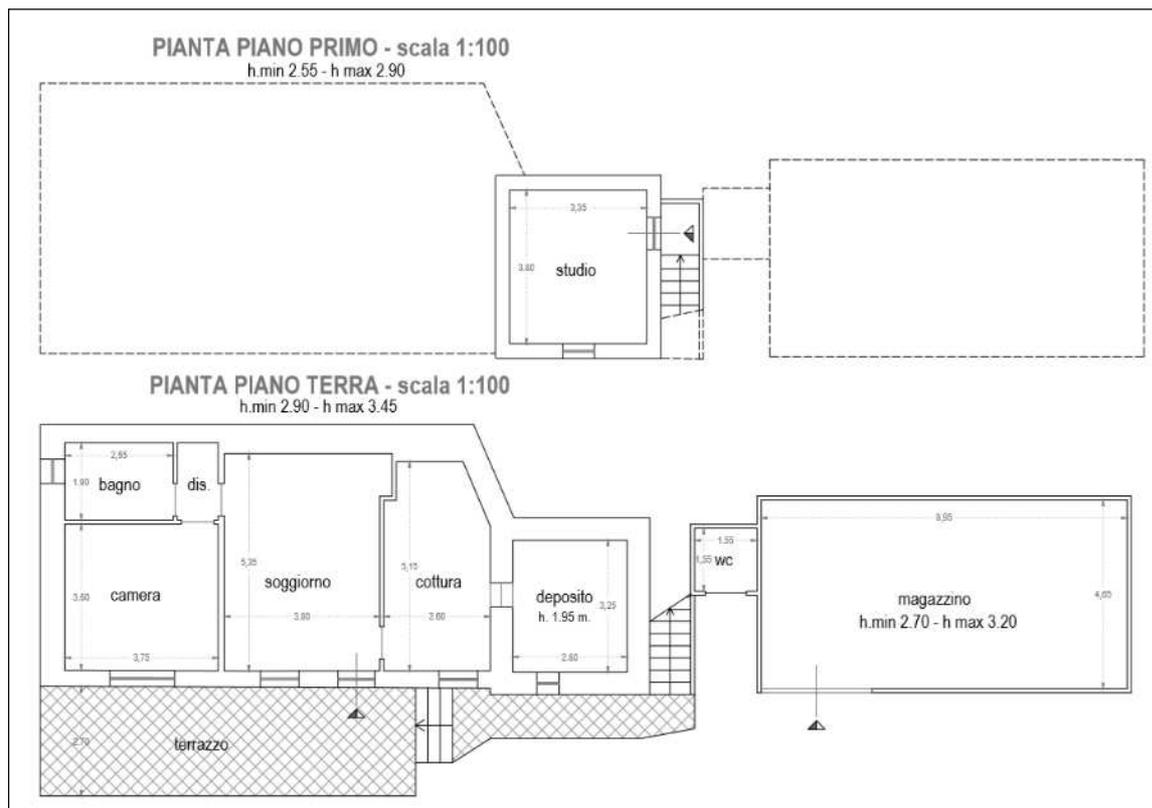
PLANIMETRIA STATO DI FATTO DELL'EDIFICIO
